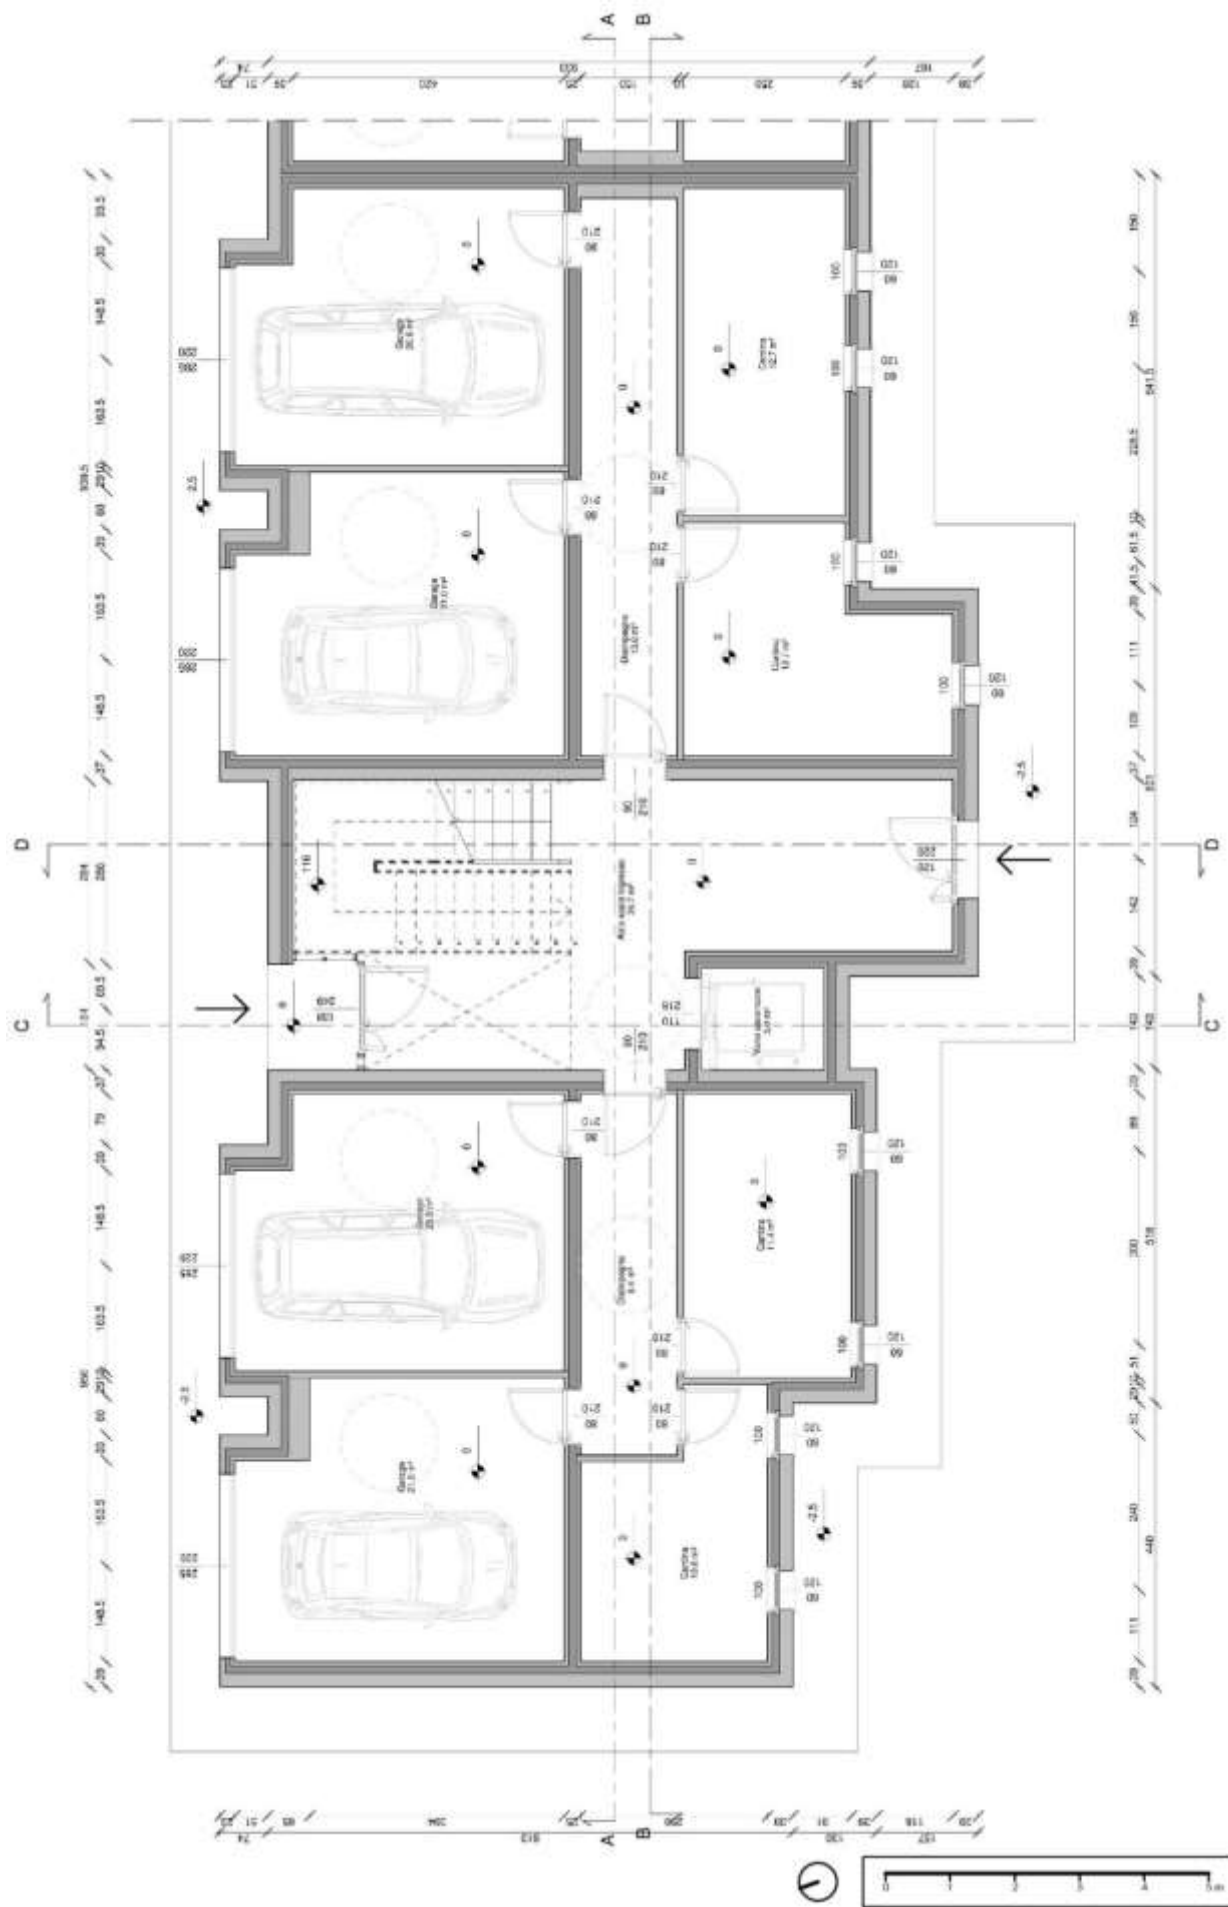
Pianta P00 del Blocco A. [Fonte: elaborazione dell'autore]
